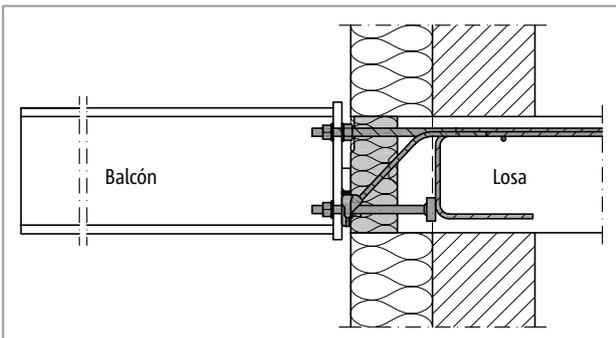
Schöck Isokorb® T tipo SK: Con ayuda del saliente de la losa, el elemento aislante cierra al ras con el aislamiento del muro. Aquí se deberán tener en cuenta las distancias laterales al borde
